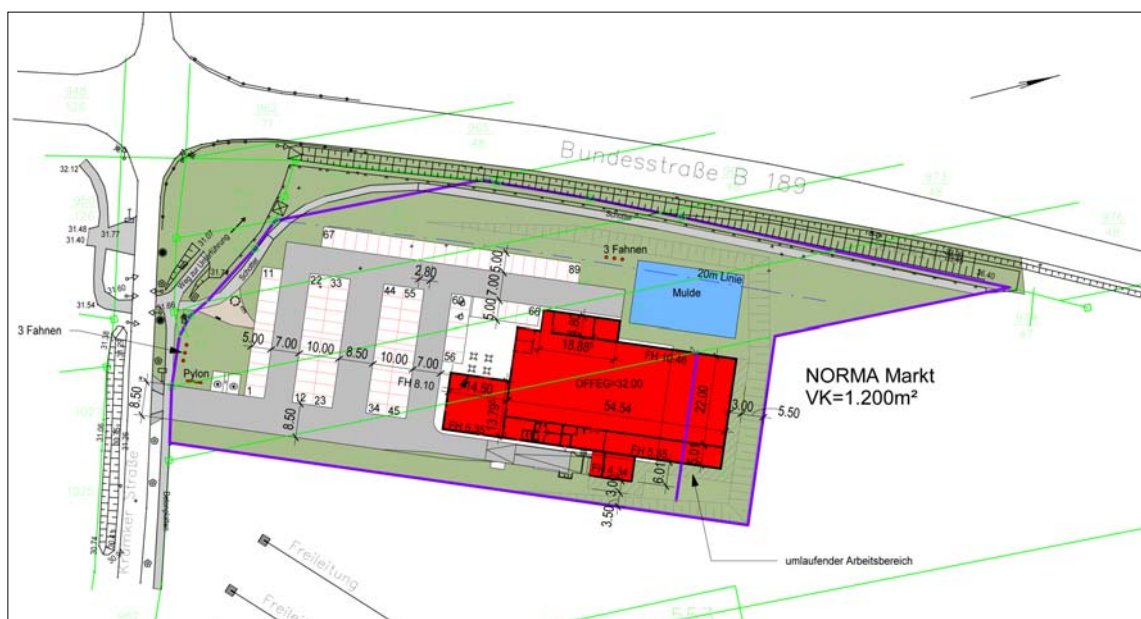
Lageplan NORMA (Quelle: Architekturbüro Düsing, Osterburg (Stand: 05.02.2019))
